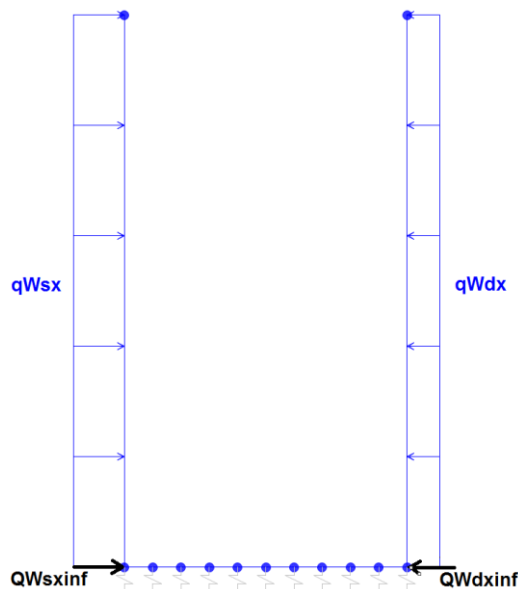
Condizione di carico SPDIX e SPSSX da SAP2000
